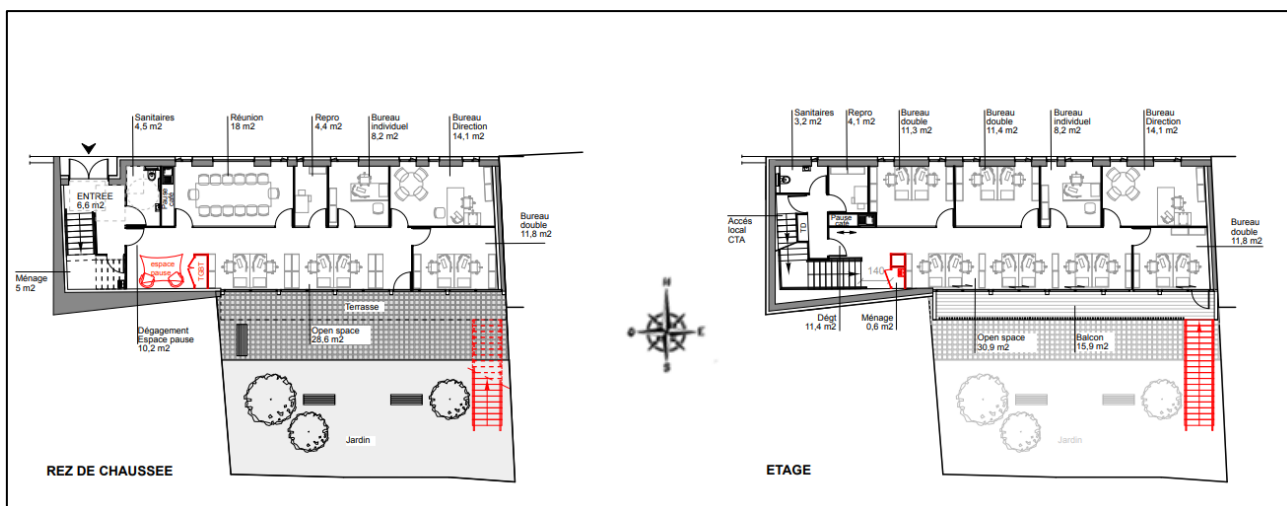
Plans des niveaux du projet en zone 2 (orange)
